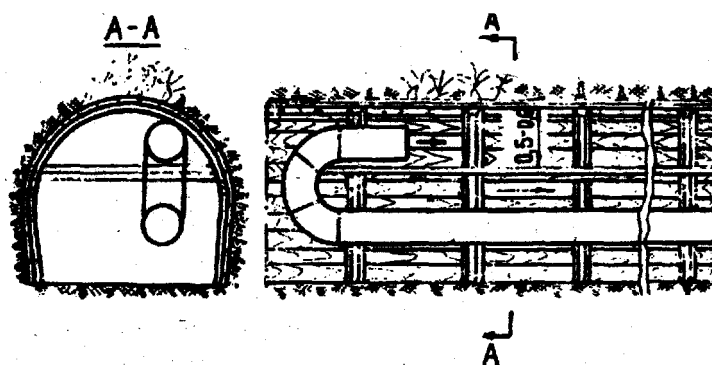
Схема размещения в выработке продольной перегородки и вентиляционного трубопровода
